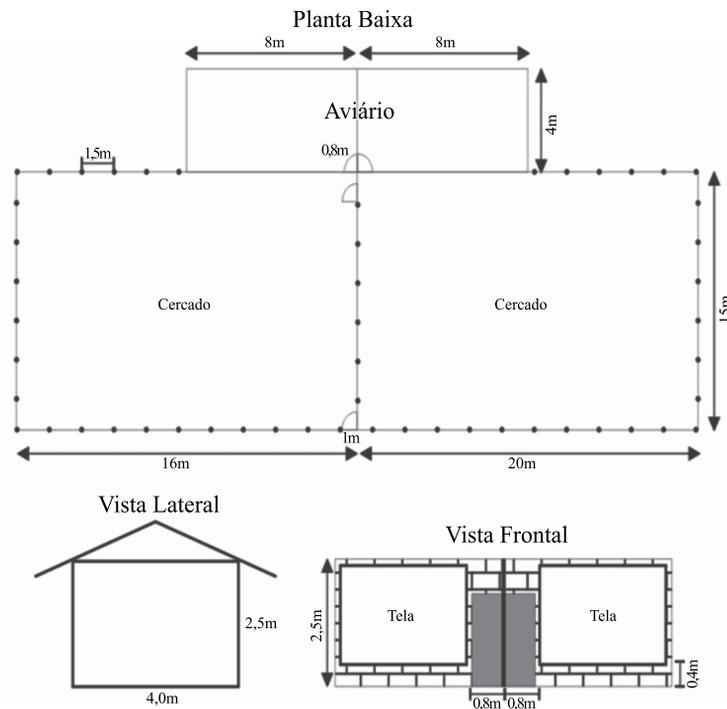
Planta baixa de um módulo familiar estabilizado para frangos de corte
